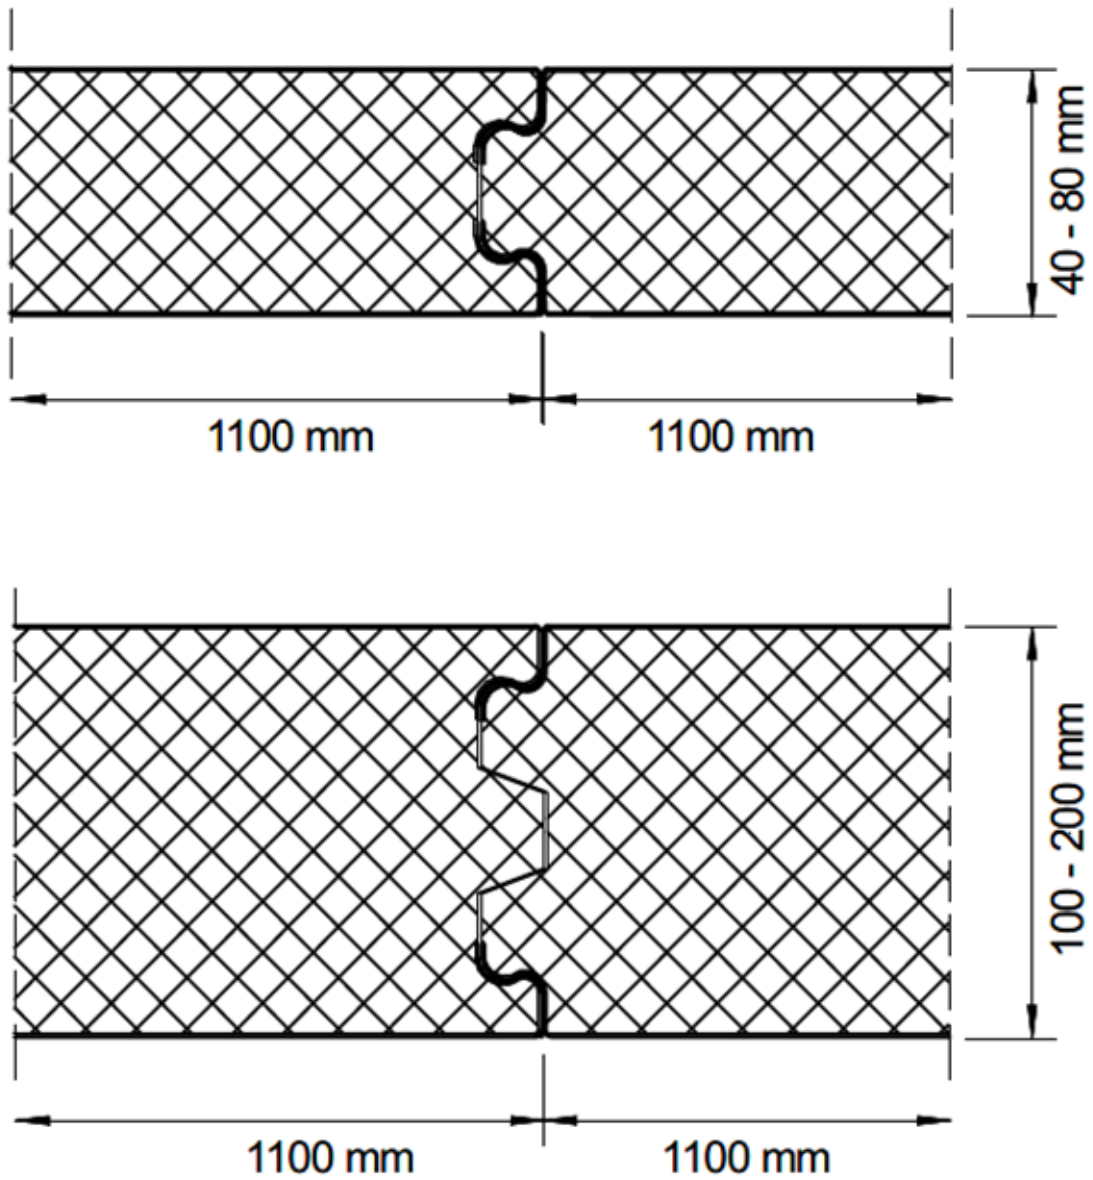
Fugenausführung der Sandwichelemente „WDI ISO COOL“ nach Angaben des Auftraggebers.
